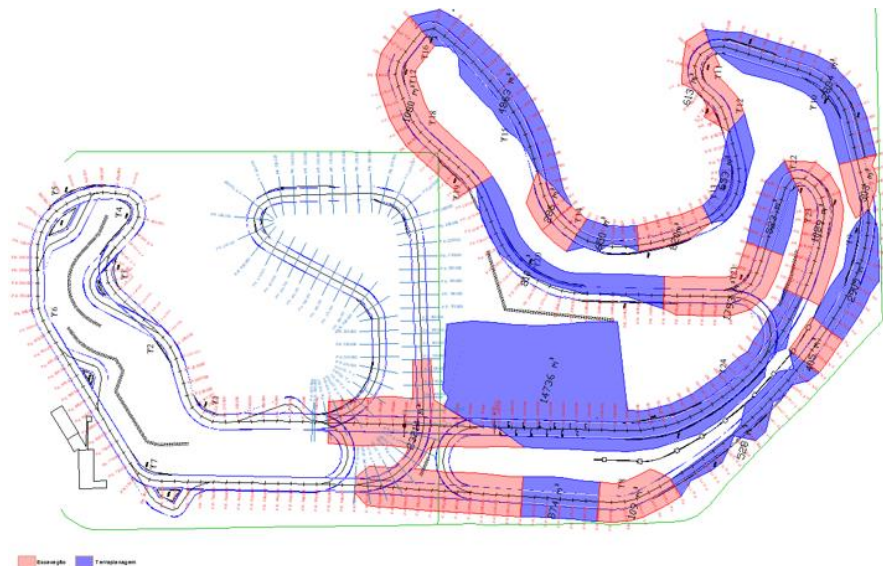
Terraplenagens e escavações a executar na zona de ampliação da pista
